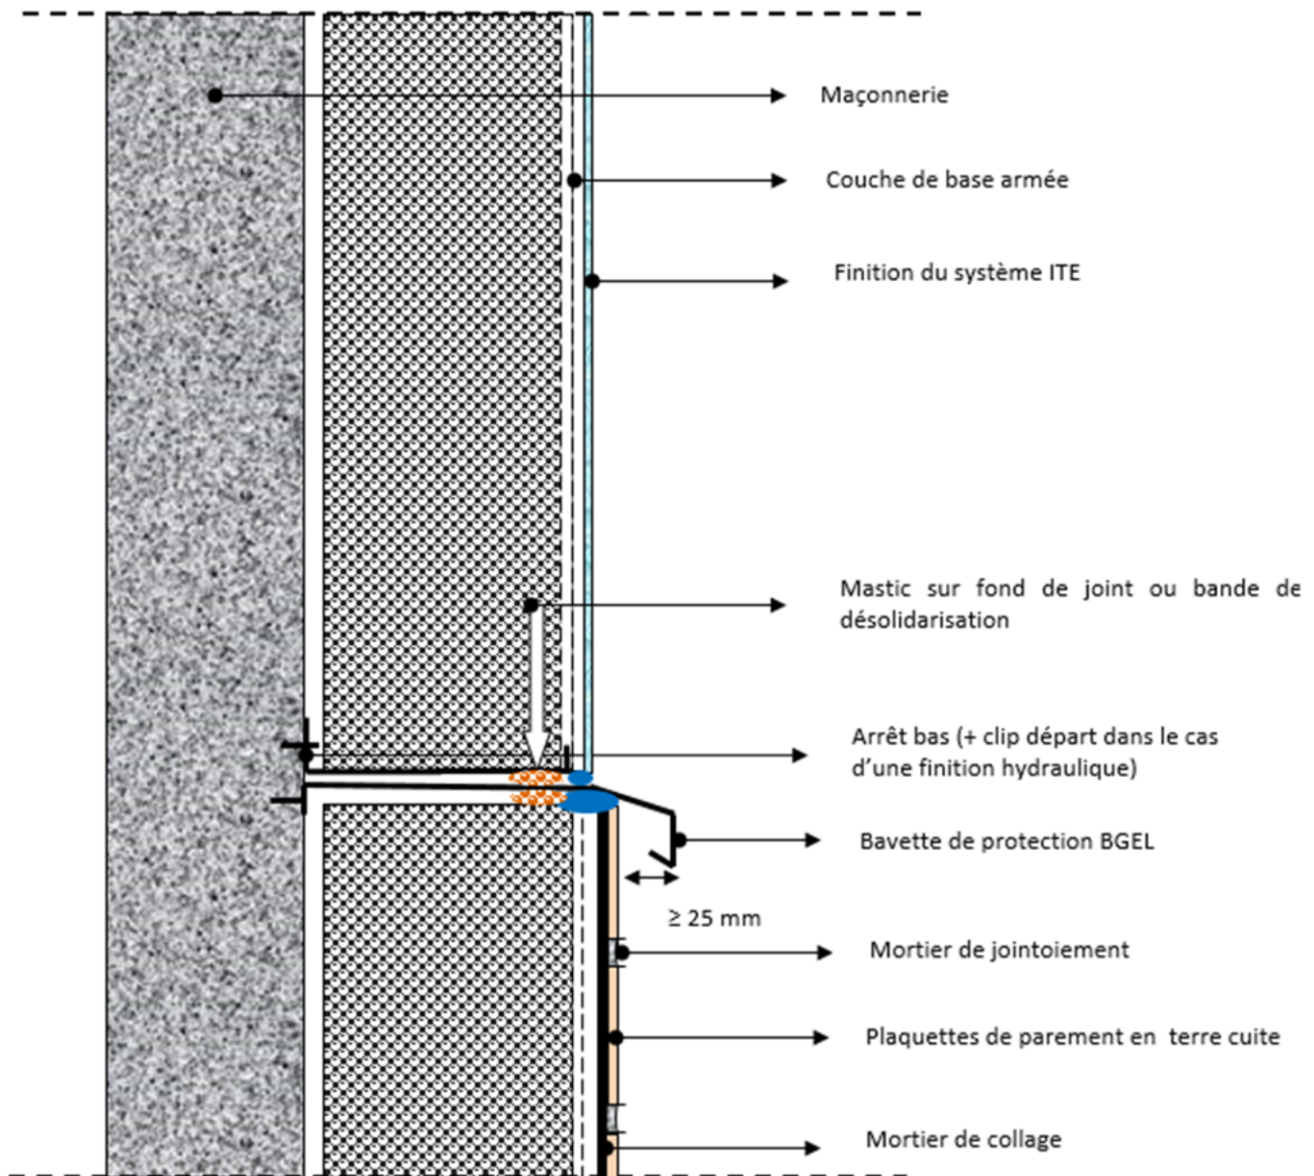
Système CHABISO P avec finition de type « plaquette de parement en terre cuite : raccordement avec un système d'enduit sur isolant (fixation de l'isolant sur la maçonnerie non symbolisée)
